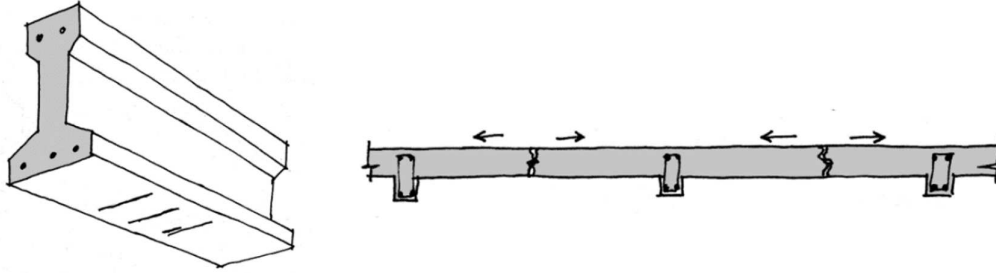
Fisuración transversal en forjados (Fuente, MPE)
